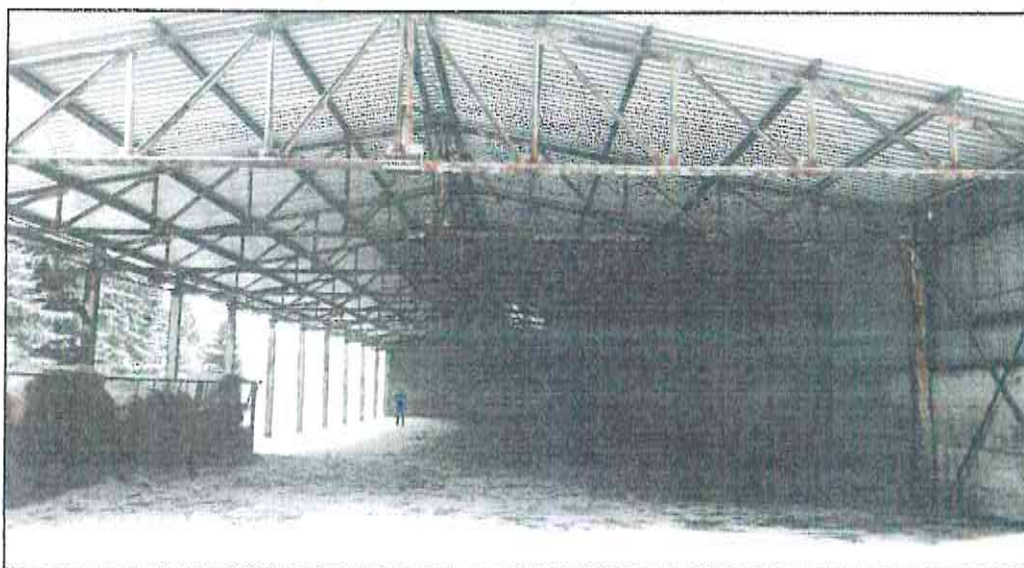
Otevřená ocelová hala na pozemku St. 1
